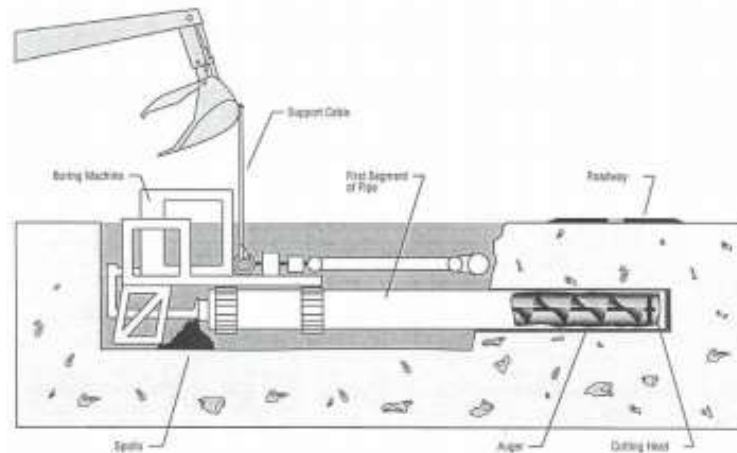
Esquema técnico Auger Boring Cradle Type Fuente: <http://rebar.ecn.purdue.edu/Trenchless/secondpage/Content/AB.htm>.
